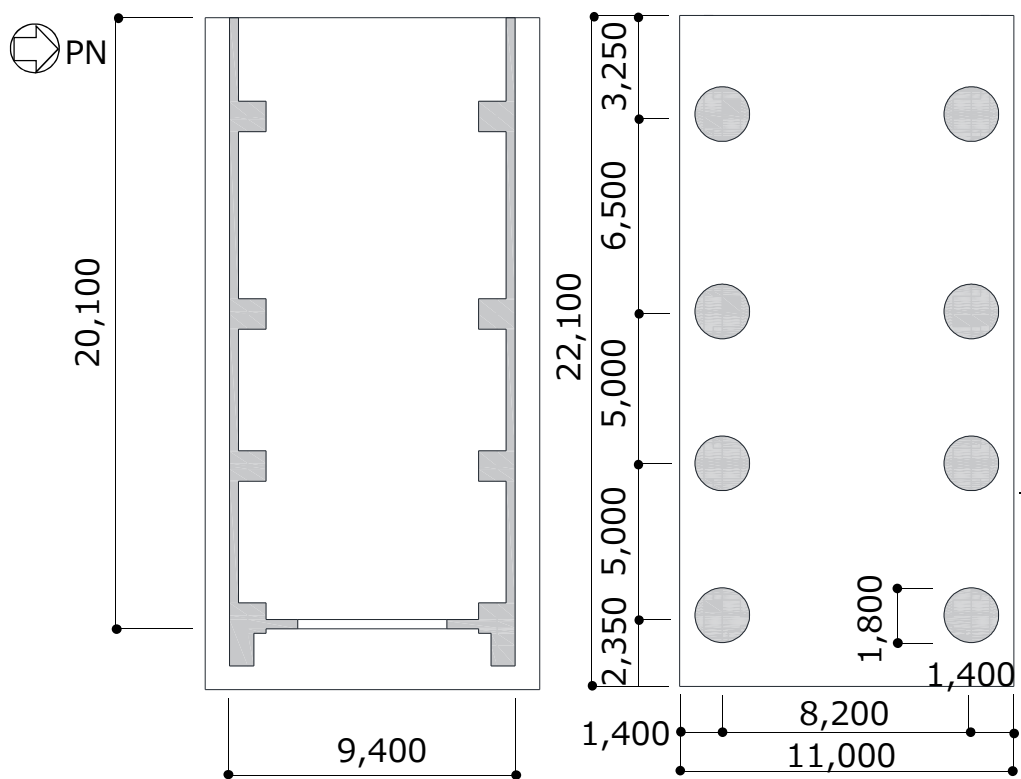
平面図（単位：mm） 図2 杭伏図（単位：mm）
